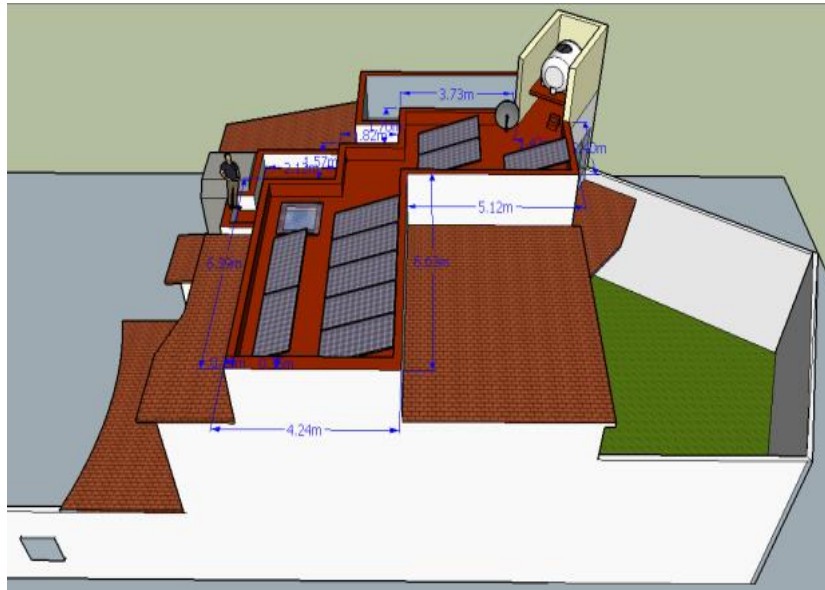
Plano 3D, Vista lateral derecha: aporte propio.
